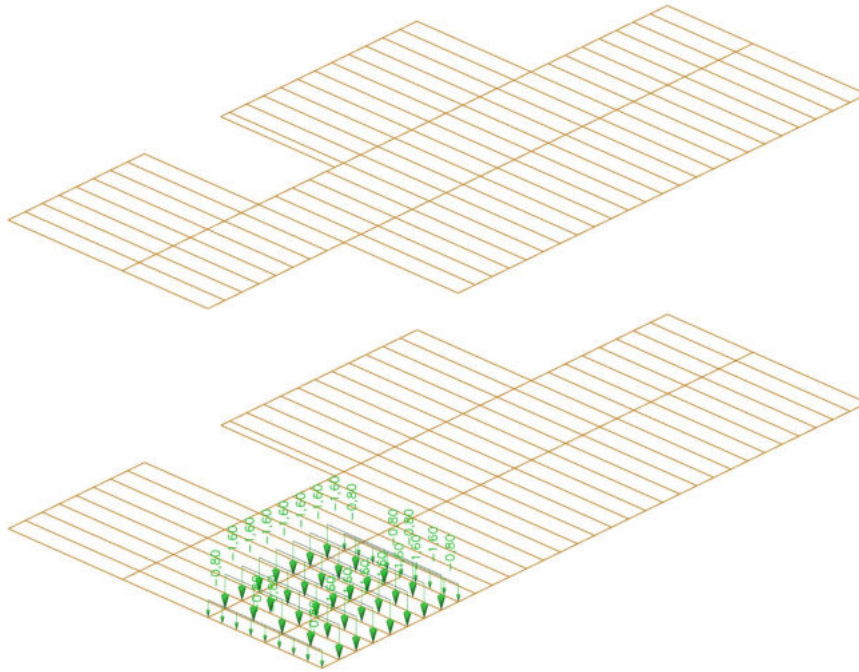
Zatížení stropní konstrukce podélným větrem zleva 1:2
